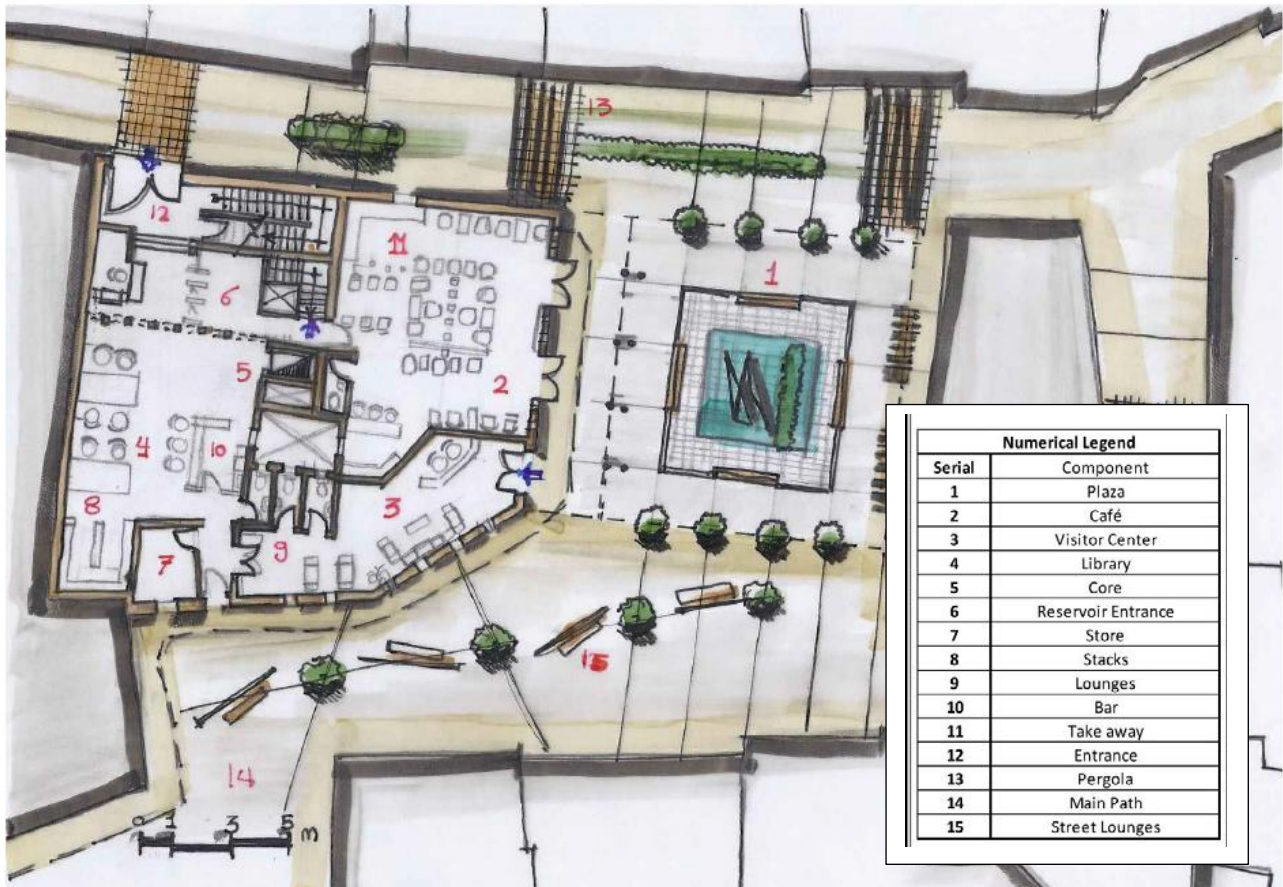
شكل للتصميم المقترح لقطعة الأرض؛ حيث سيتحول بيت سيد درويش إلى مركز ترحيب
